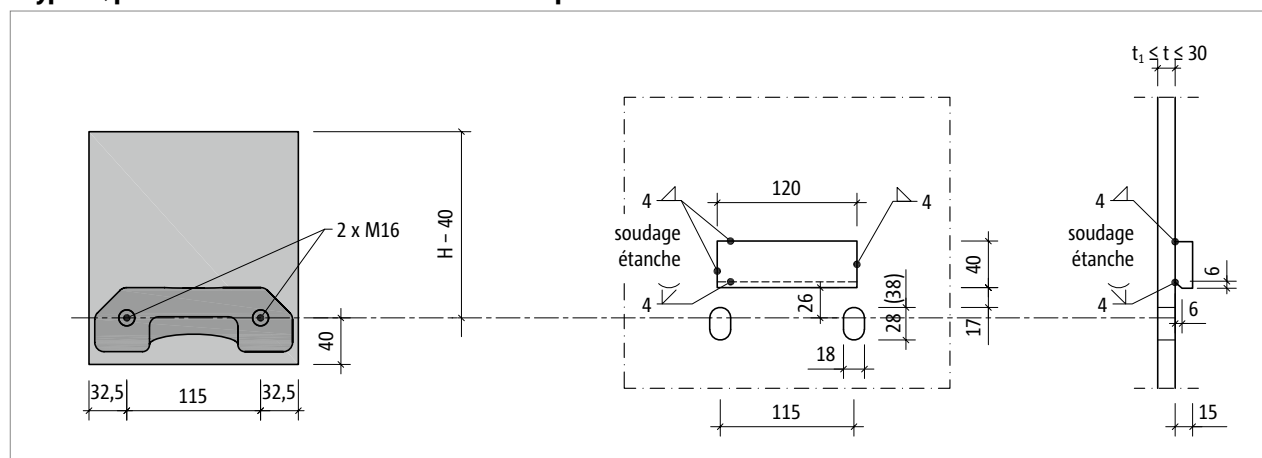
Schöck Isokorb® T type SQ : construction de la platine frontale de raccordement
